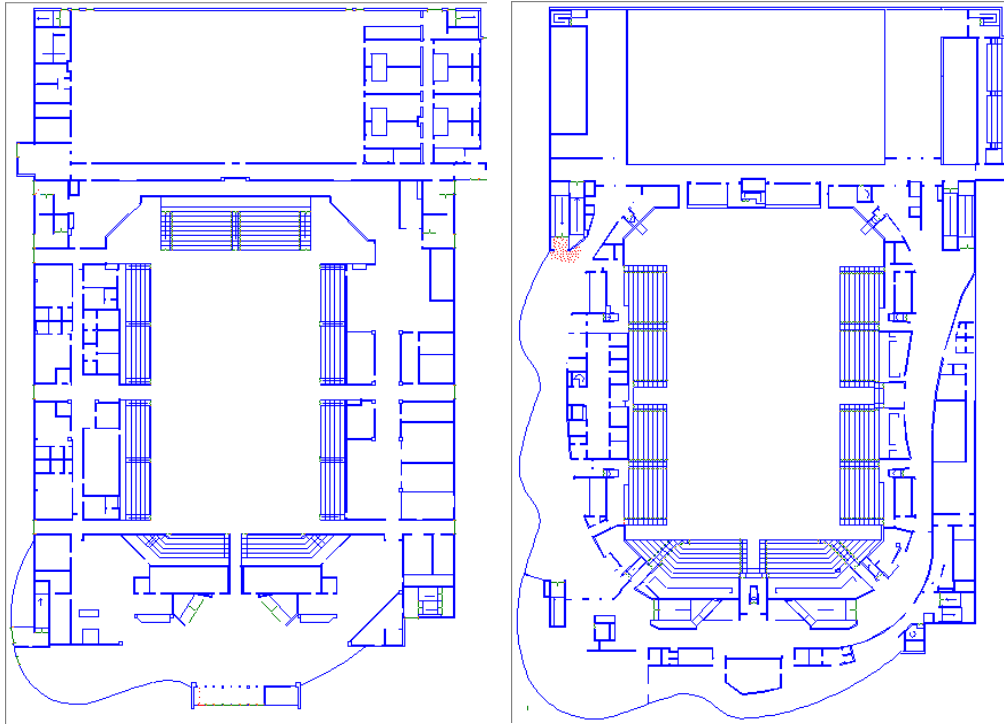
Simuleringens utseende efter 300 sekunder. Till vänster syns plan 1 och till höger plan 2.
